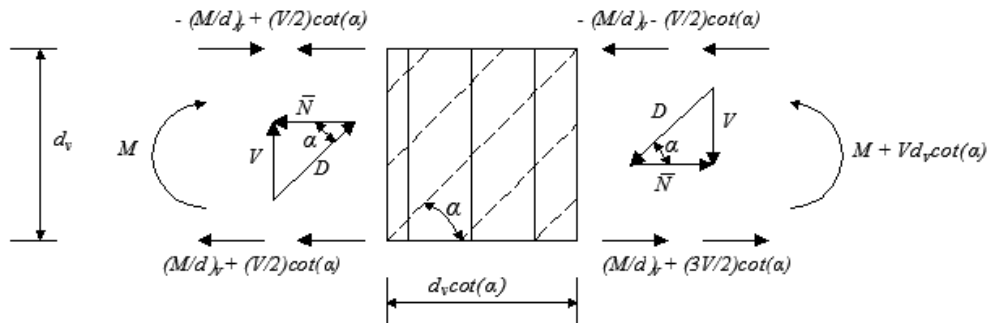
Elemento A do modelo de treliça plana ilustrado na Figura 27 [14]
